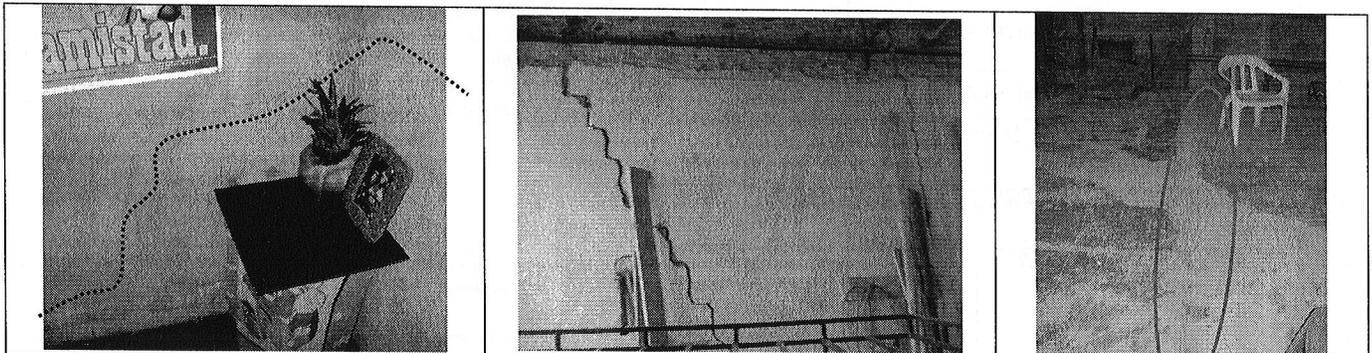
Evidencia de fisuras en muros de cerramiento perimetral y divisorios al interior de la vivienda emplazada en el Lote 18 de la Manzana U9.
